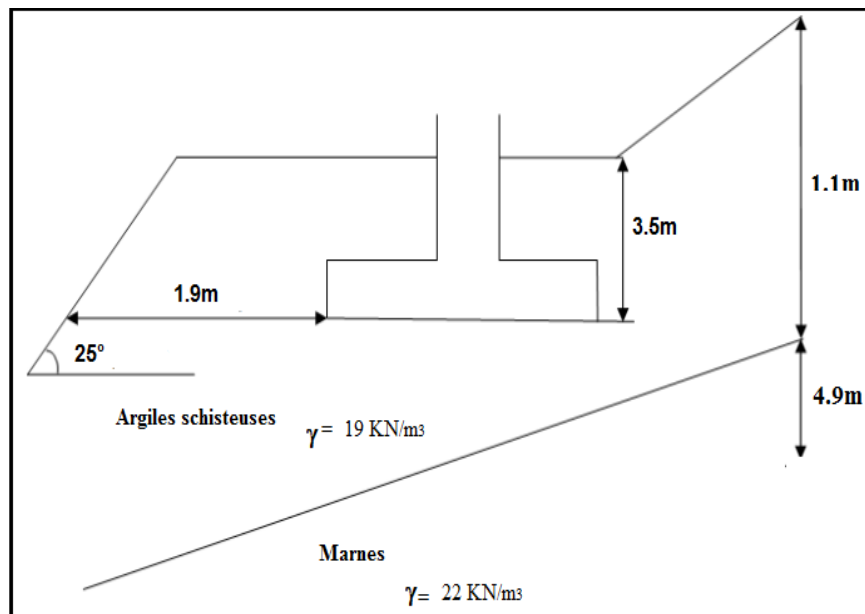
coupe sur le profil de sol sous la fondation (SP1).
